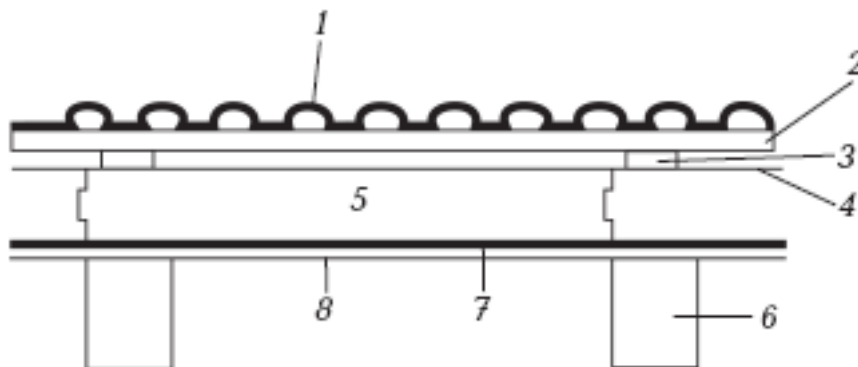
Укладка теплоизоляции выше стропил с гидроизоляционным защитным слоем: 1 – кровельное покрытие; 2 – обрешетка; 3 – брусок; 4 – ветро-, влагозащитная мембрана; 5 – утеплитель; 6 – стропила; 7 – гидроизоляция; 8 – обрешетка
